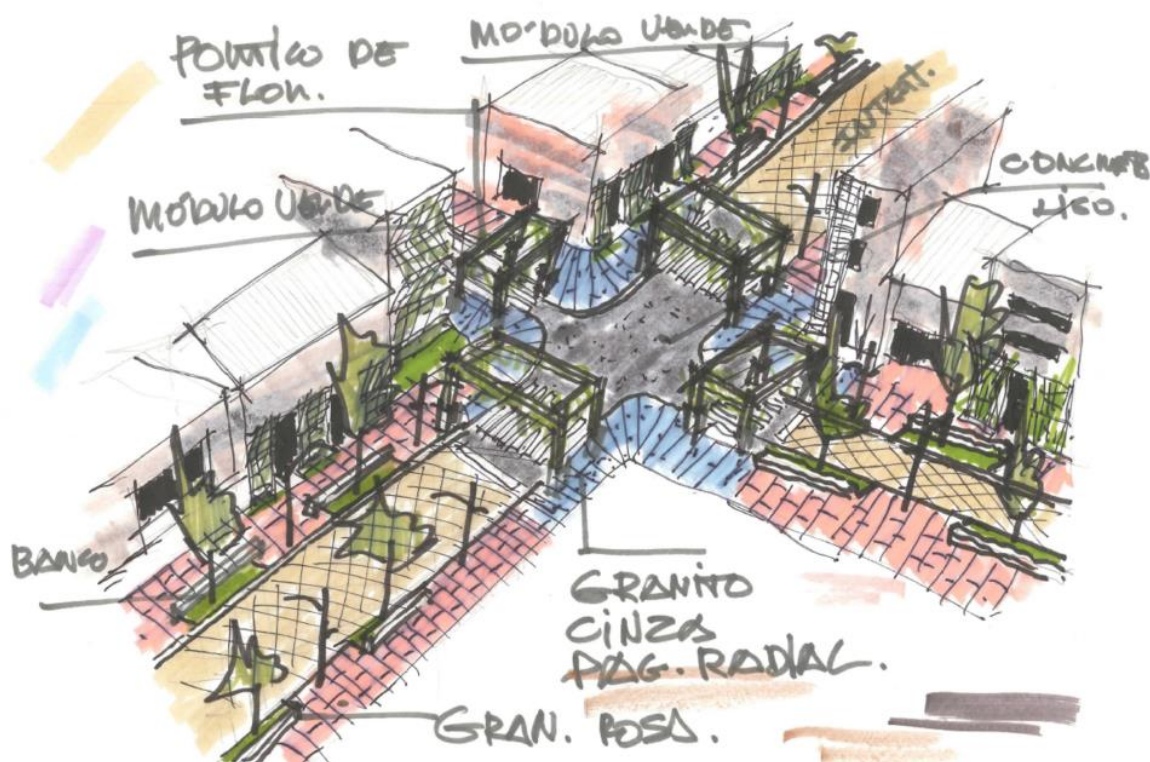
Croqui Projeto Obra Prioritária – Bem Vindo.
